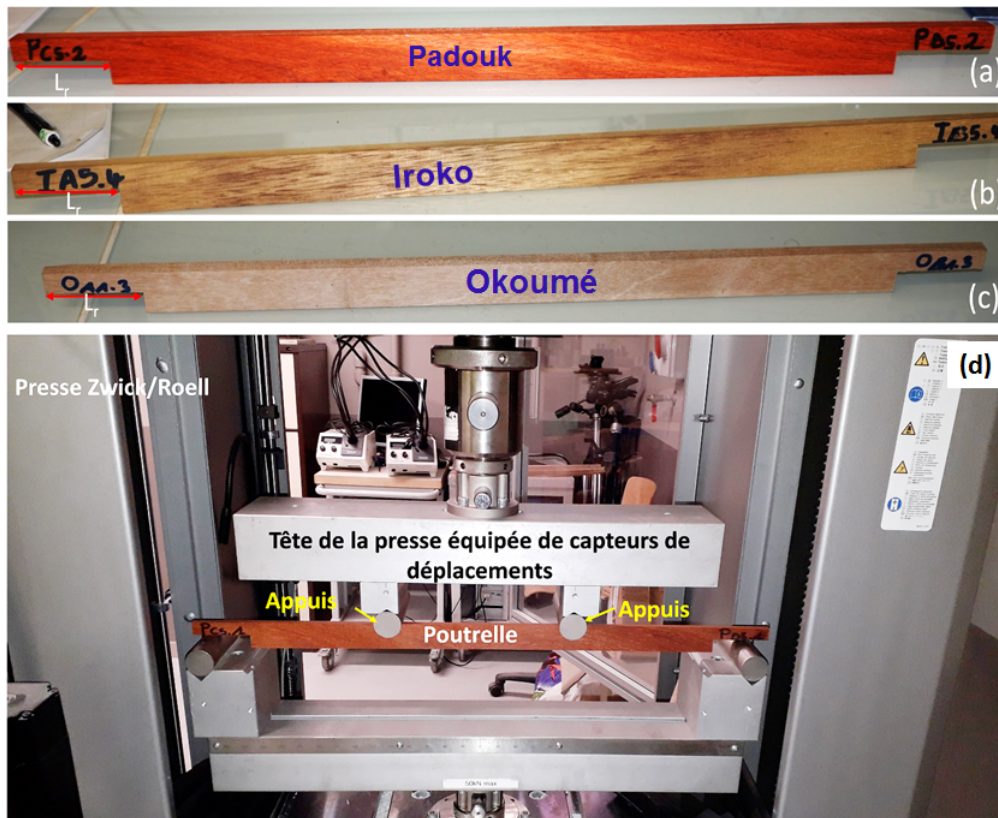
Poutrelles de Padouk (a), d'Iroko (b) et d'Okoumé (c) avant les essais statiques; (d) Poutrelle de Padouk entaillée en essais statique.
